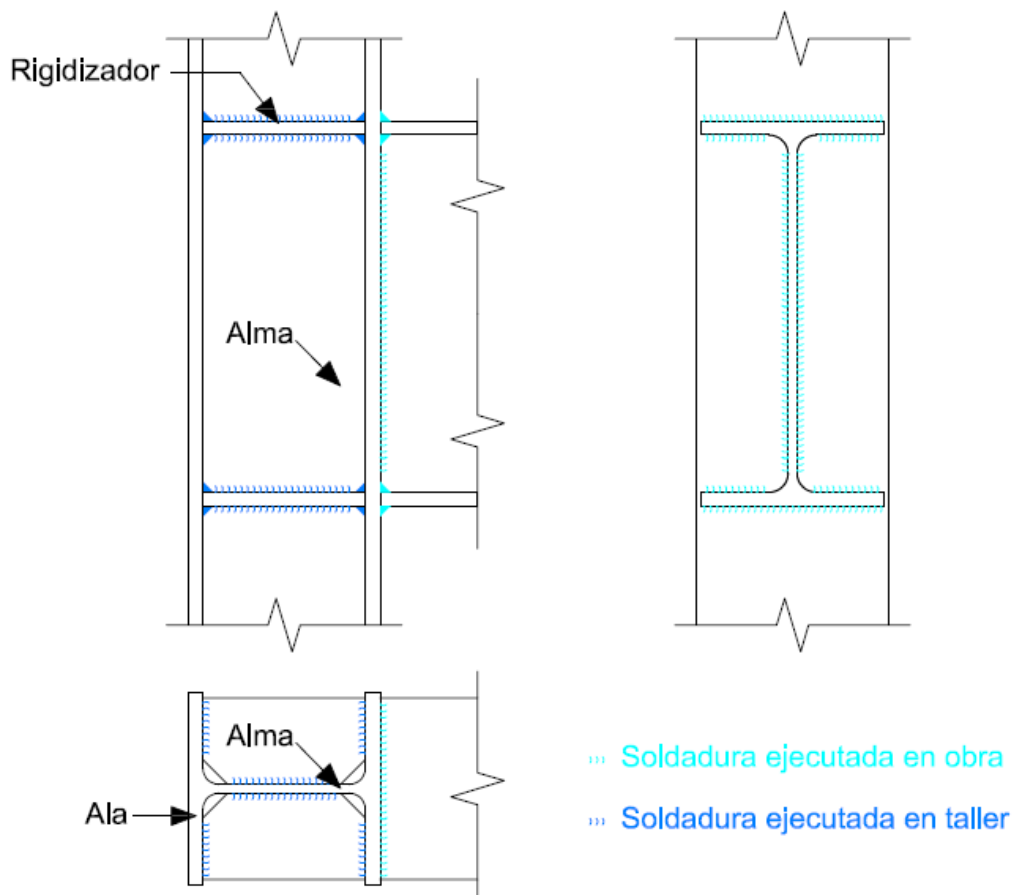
Detalle unión pilar-viga soldado en obra.
